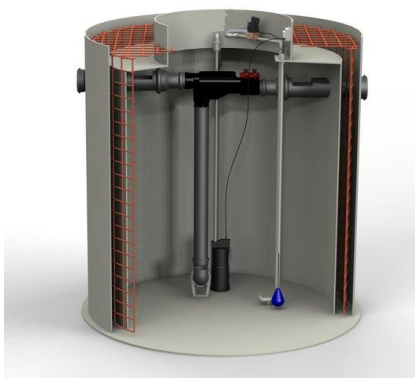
Podzemní prefabrikovaná betonová skládaná retenční nádrž ($V = 59,3 \text{ m}^3$) [13]
